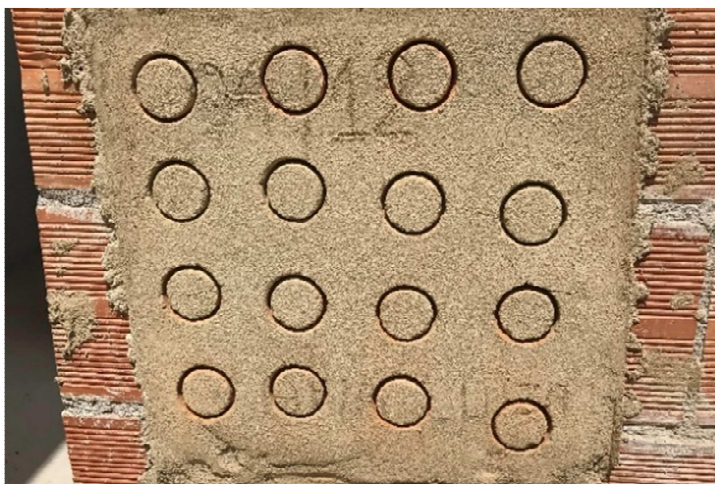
Distribuição das amostras na parede para ensaio de aderência a tração.
